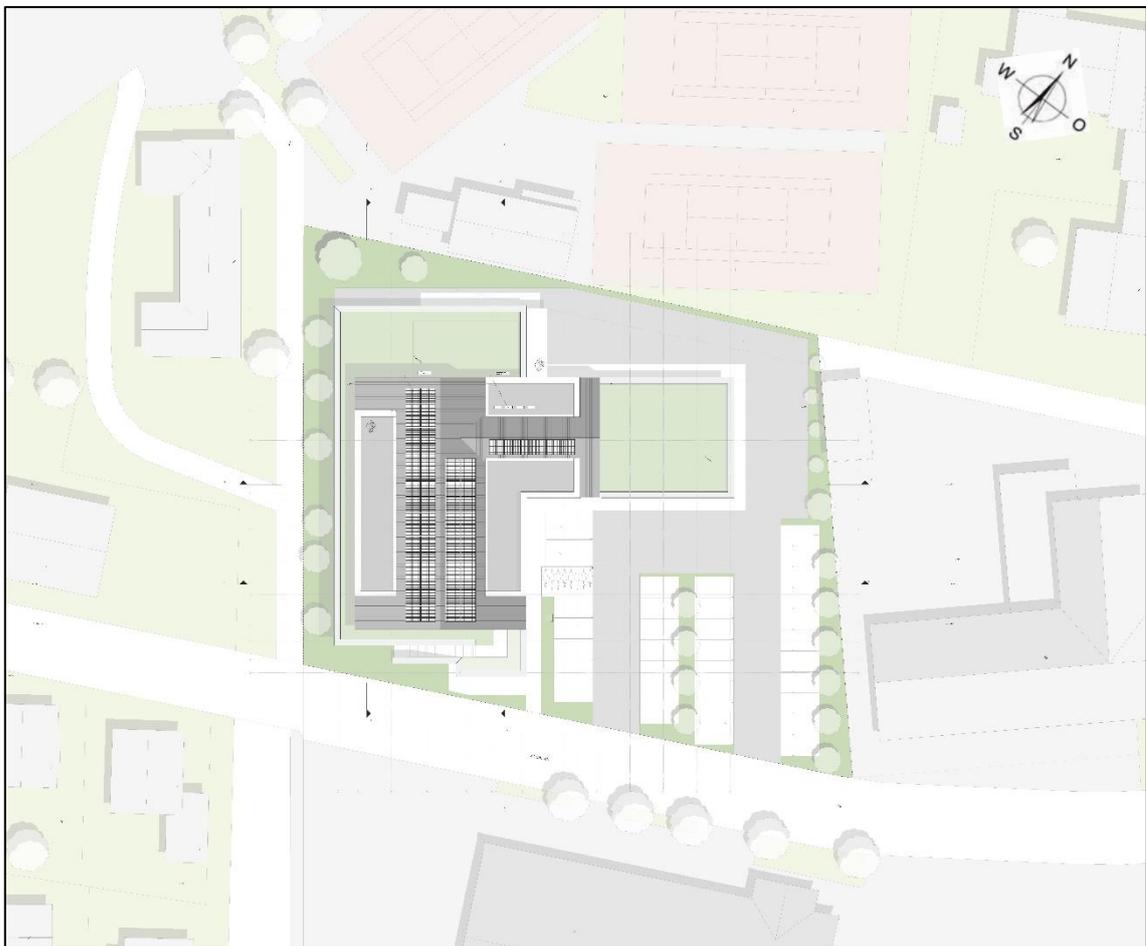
Lageplan zum benachbarten Bauvorhaben /18/
